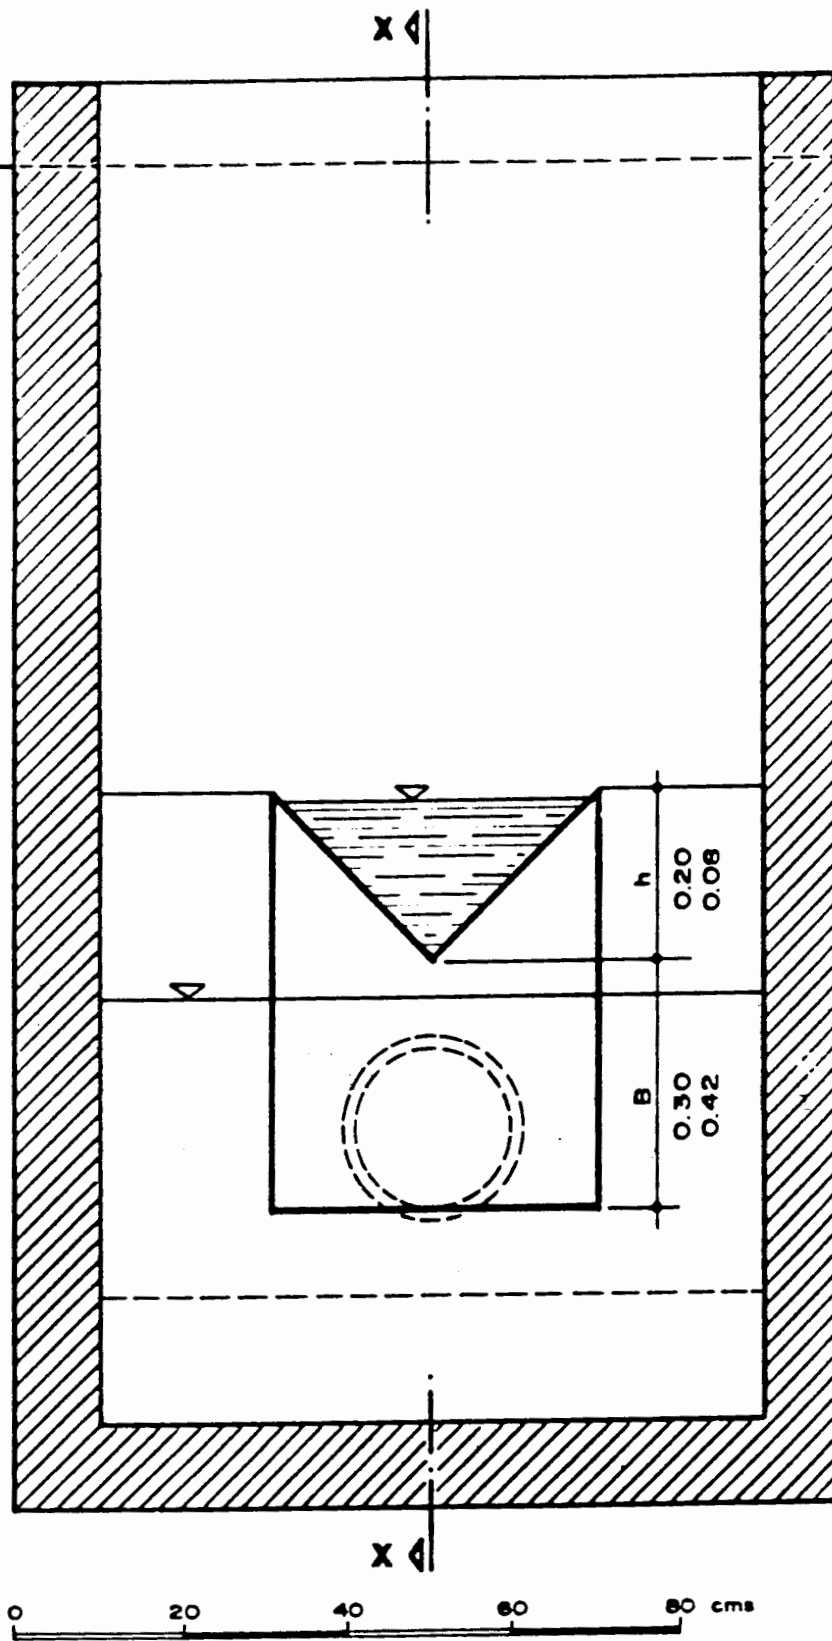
DETALLE DE LAS ESTRUCTURAS DE INTERCONEXION
